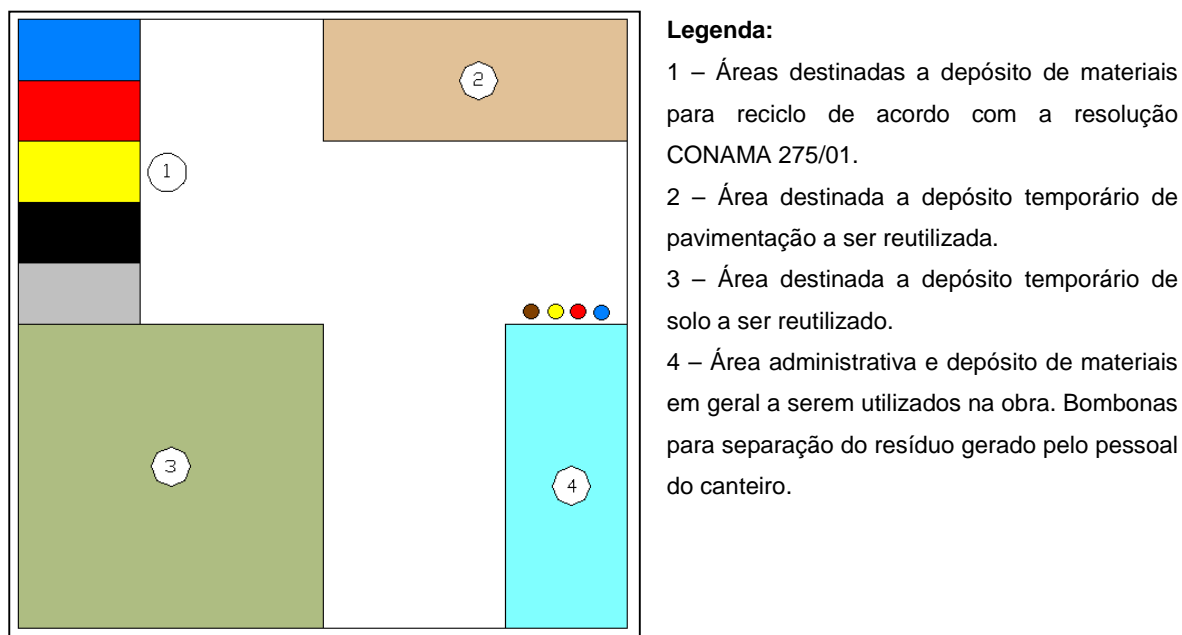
Planta esquemática (*layout*) do canteiro de obras.
